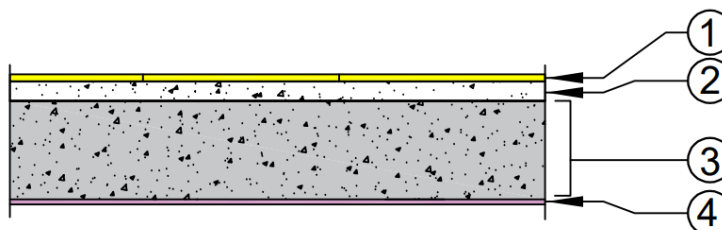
coupe dalle pleine des balcons DP, DP2, DP3, et DP4 (accessibles).
